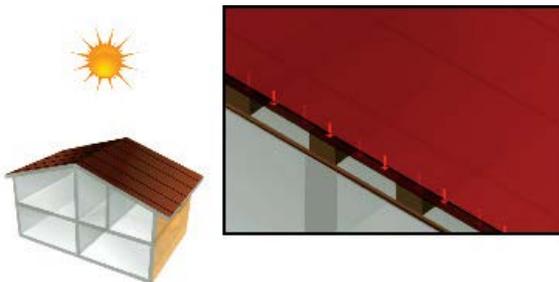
Aquecimento estrutural em função da condução do calor do telhado
